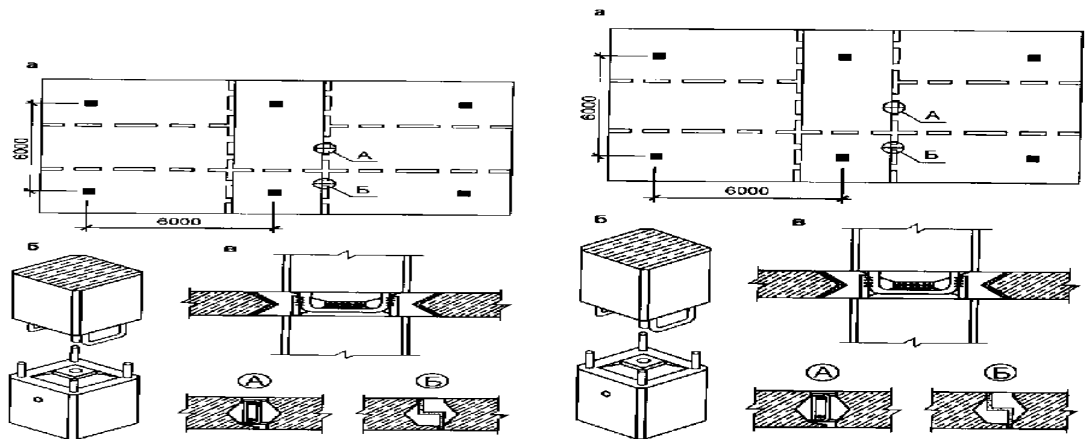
Сборно-монолитный безригельный каркас КУБ-2,5: а - монтажная схема; б - стык колонн; в - узел «колонна-плита»
